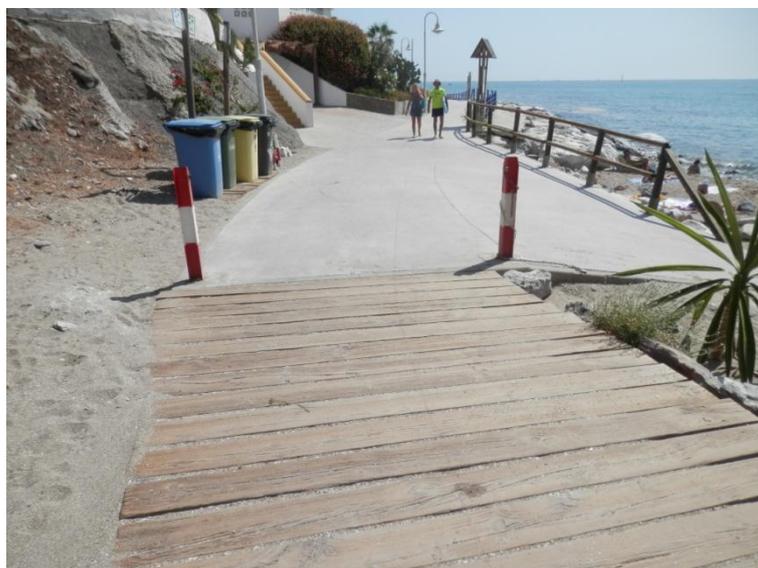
Límite entre tramo de escollera y playa: pavimentos de hormigón y madera.
